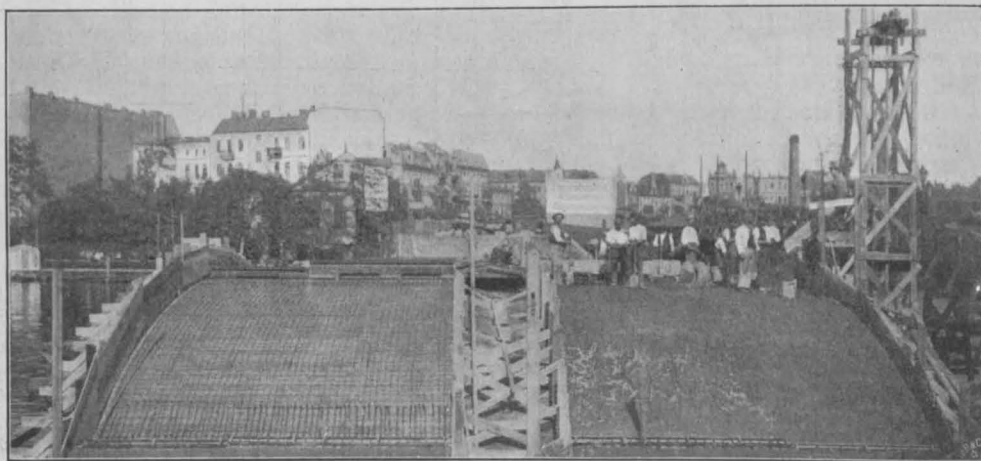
Ausführung des Eisenbeton-Gewölbes.
